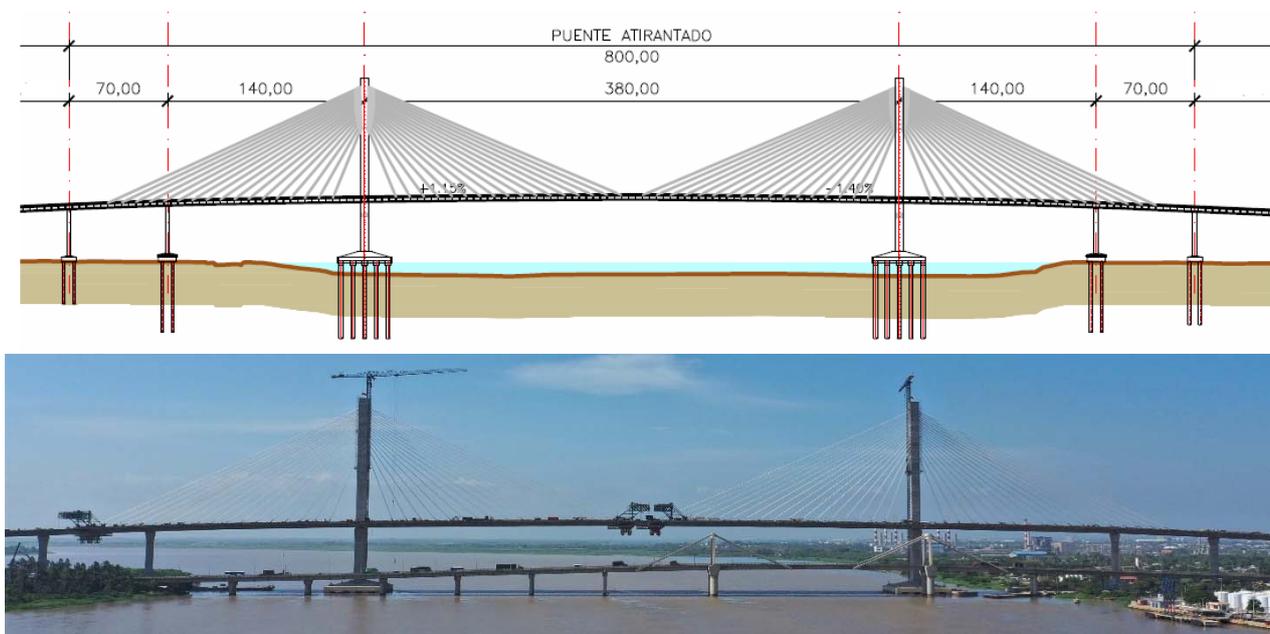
Alzado general del tramo atirantado en planos y en la realidad
